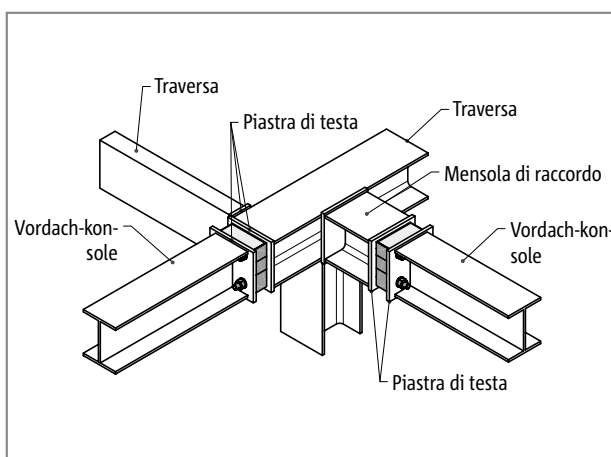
Schöck Isokorb® T tipo S: angolo esterno
